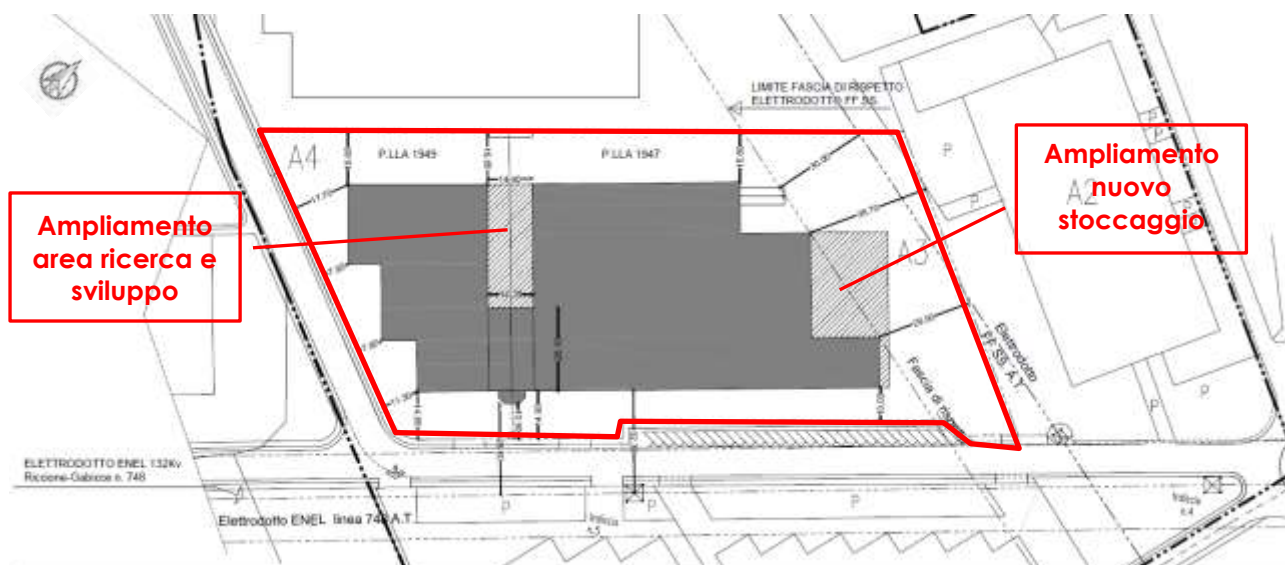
a – planimetria di progetto – nelle aree a tratteggio e nuove
